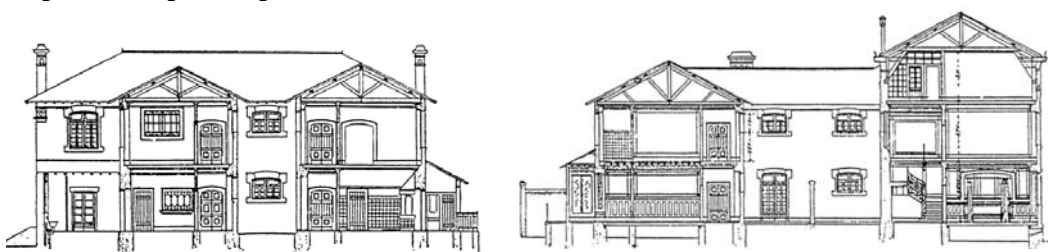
Casa do Sr. Manuel d'Almeida – Corte transversal e longitudinal.
